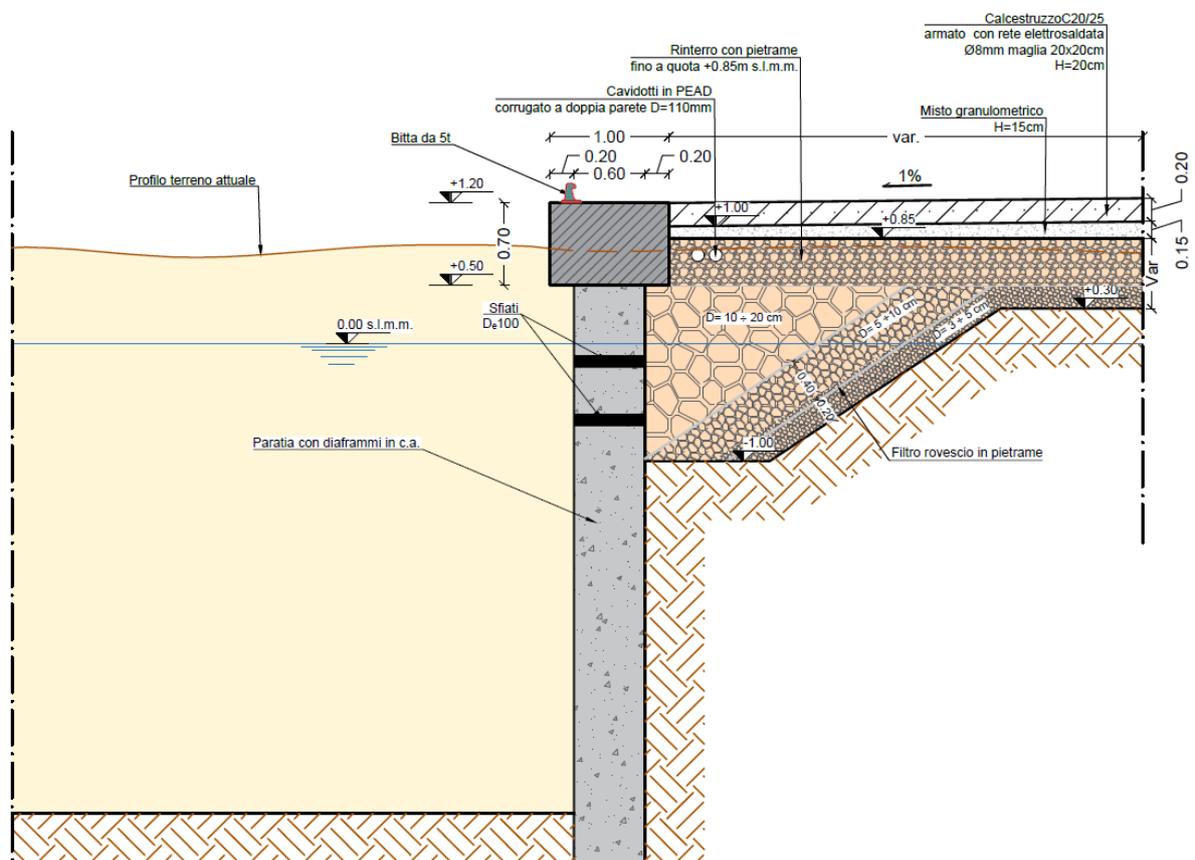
Sezione tipo banchina con paratia realizzata in diaframmi, nella fase antecedente il dragaggio
